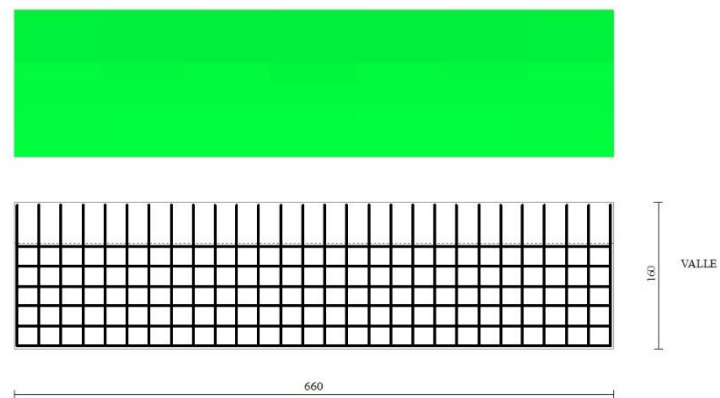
Piastra fondazione dir. Y (Inviluppo)
